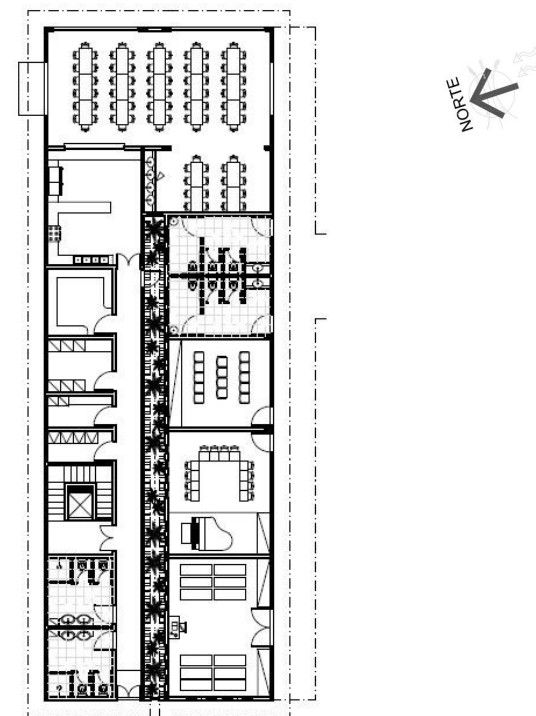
Planta Baixa – Bloco do Ensino II, Serviços e Refeitório.
